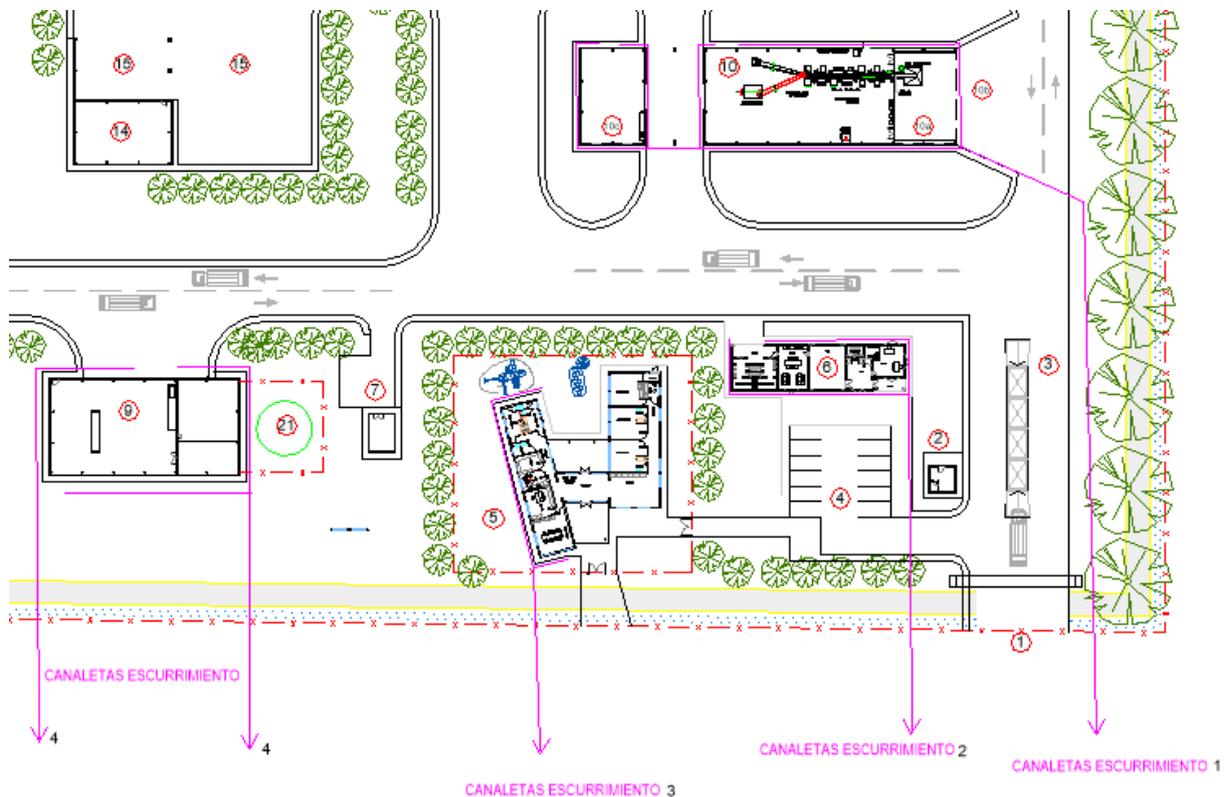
Disposición de las canaletas en la Planta de Allen (canaletas 1, 2, 3 y 4).
